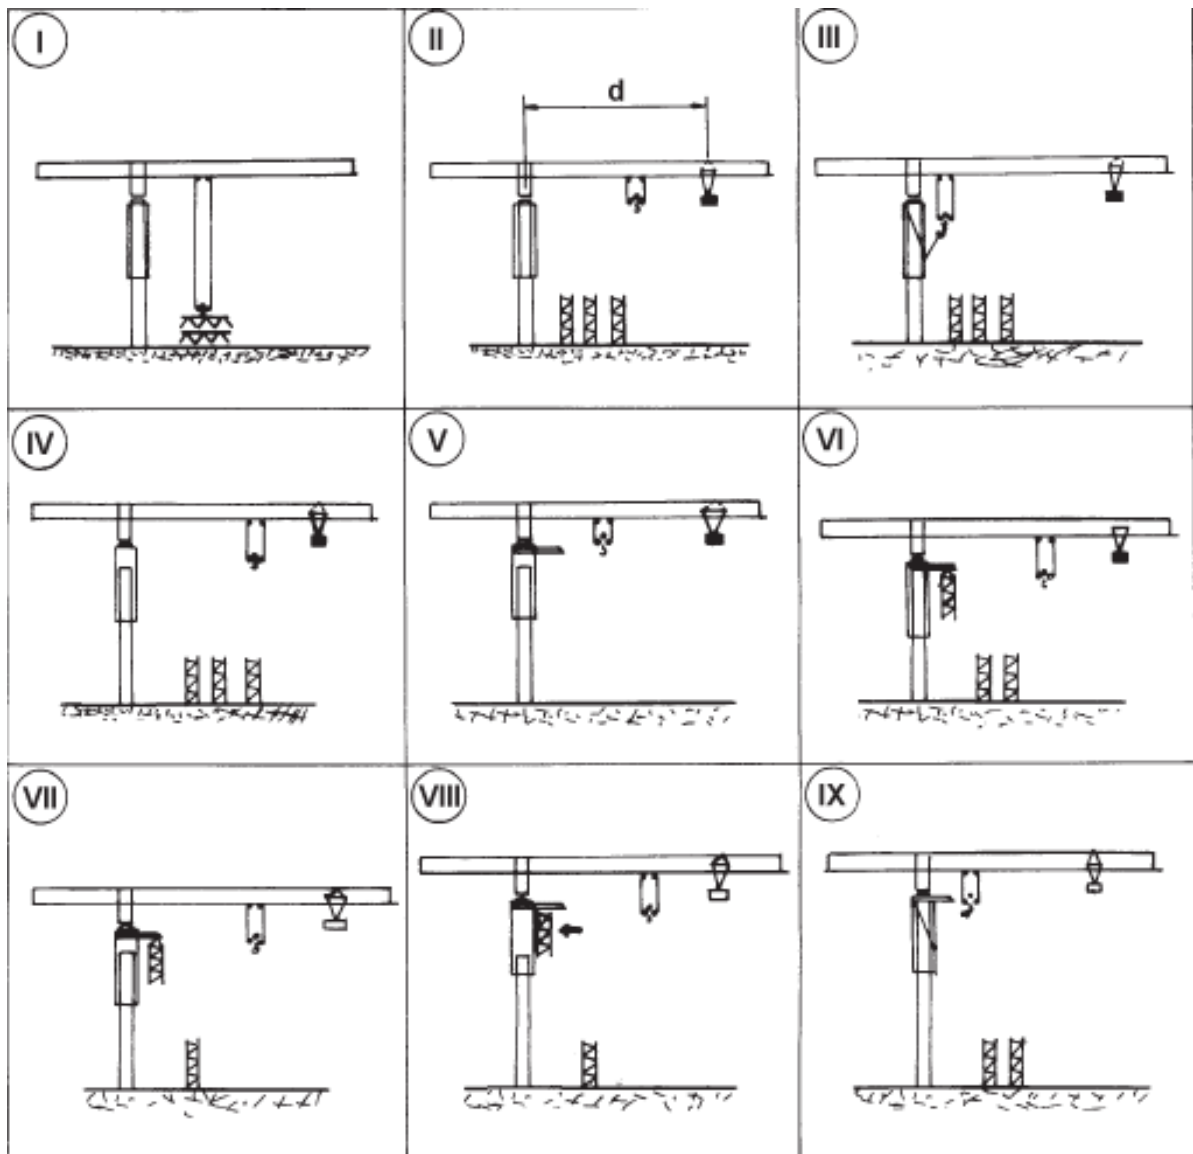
Secuencia de trepado de la grúa telescópica
